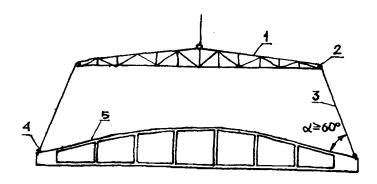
Сехма строповки панели-оболочки при съеме изделия с формы и складировании 1-несущая конструкция траверсы; 2-консоли с блоками; 3-тросы; 4-монтажная петля с откидным кольцом; 5-панель (ССС)
